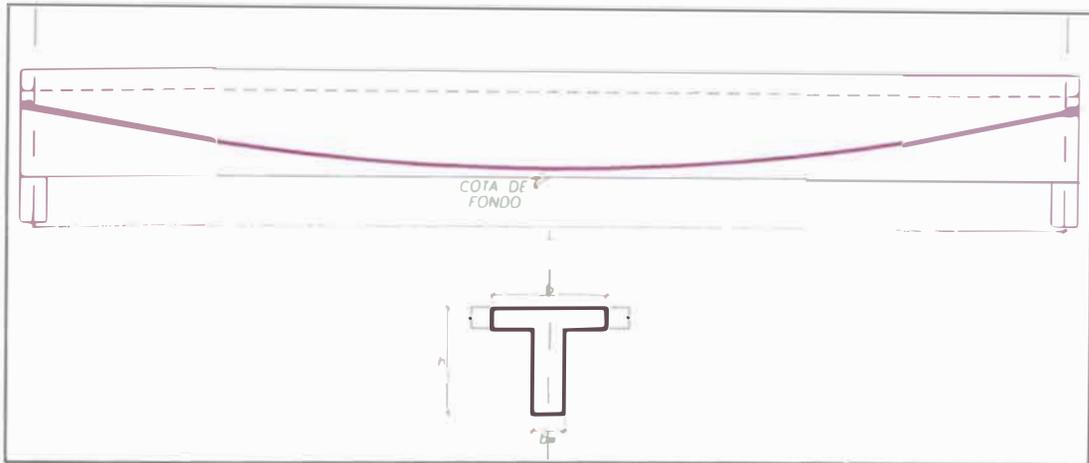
Viga Postensada Simplemente Apoyada
